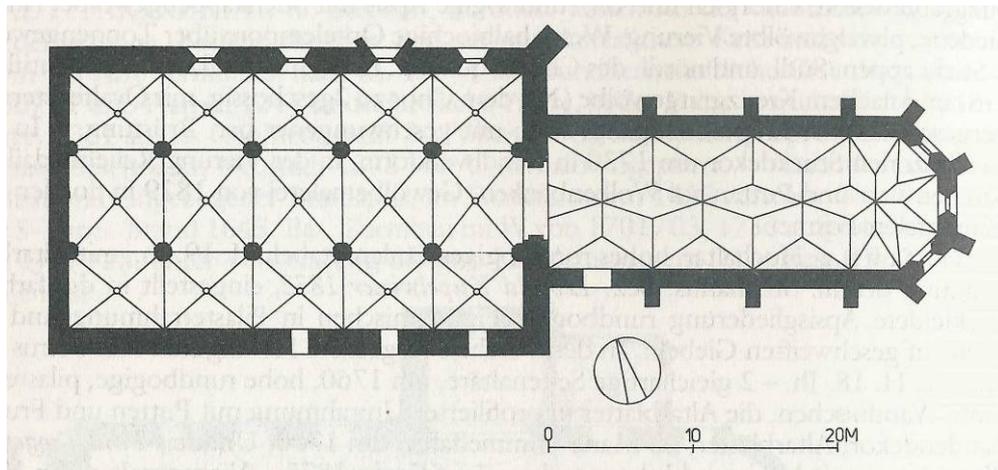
Retz - Dominikanerkirche; Grundriss
